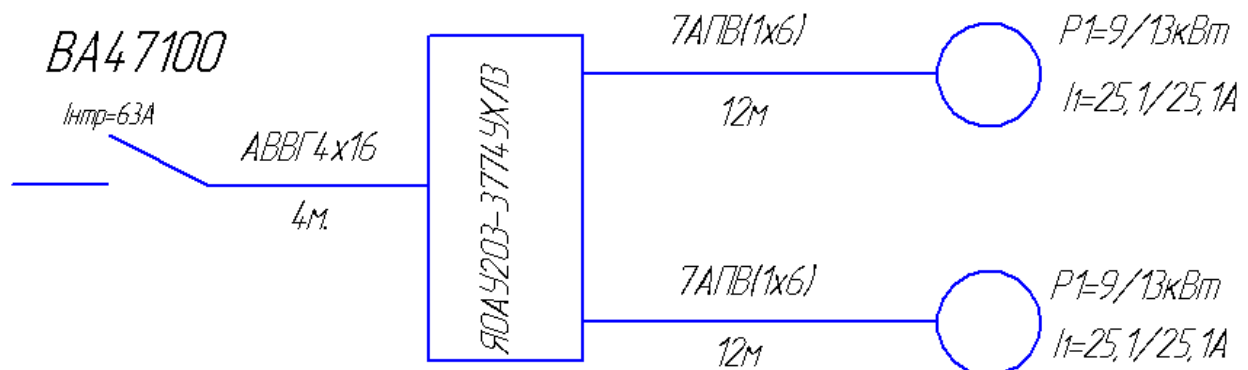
Розрахункова схема силової електропроводки до тепло-вентиляторів
